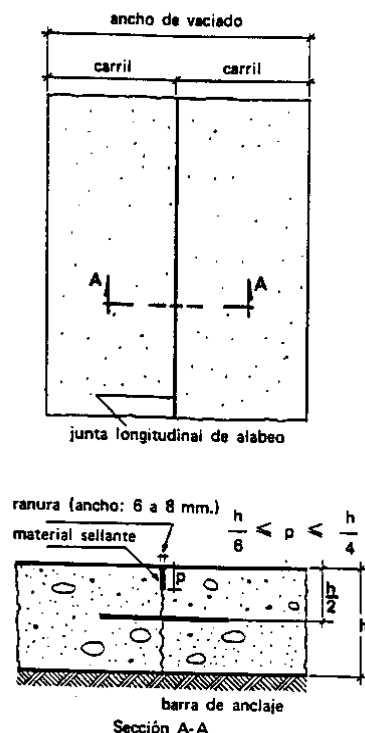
Junta longitudinal para pavimento vaciado en todo su ancho
